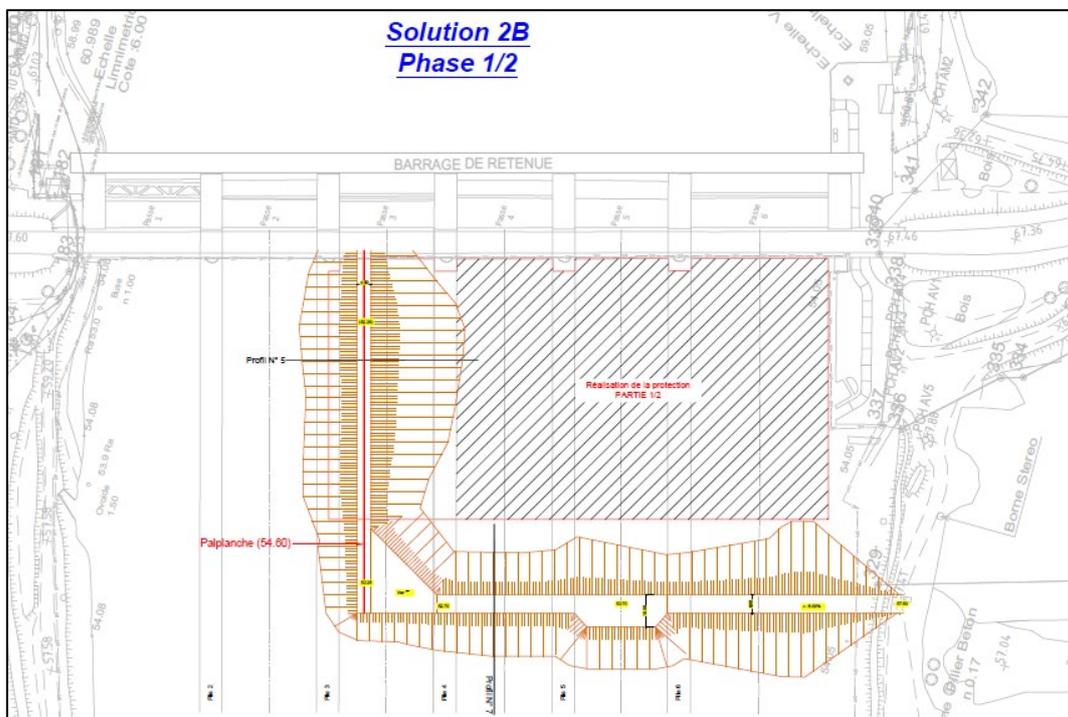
Vue en plan des batardeaux de la solution 2b – phase 1/2
